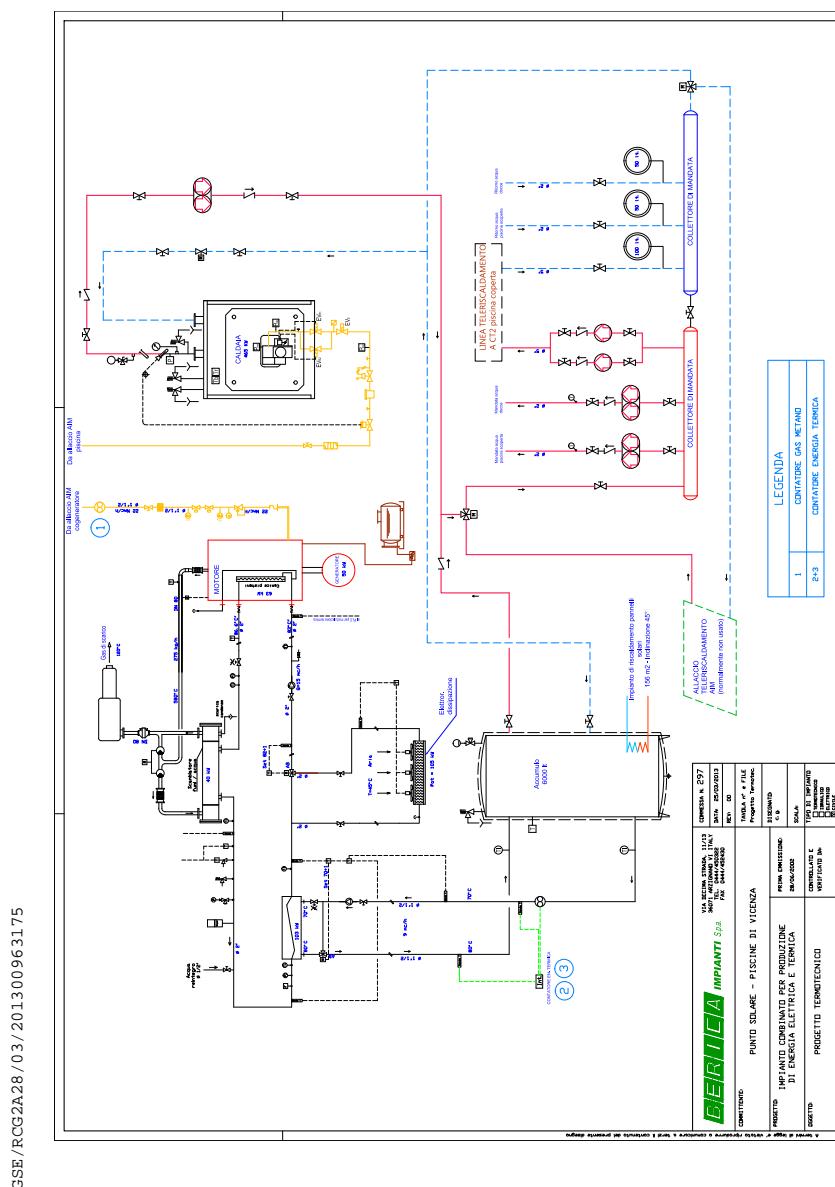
Progetto preliminare impianti di generazione di un sito analizzato
